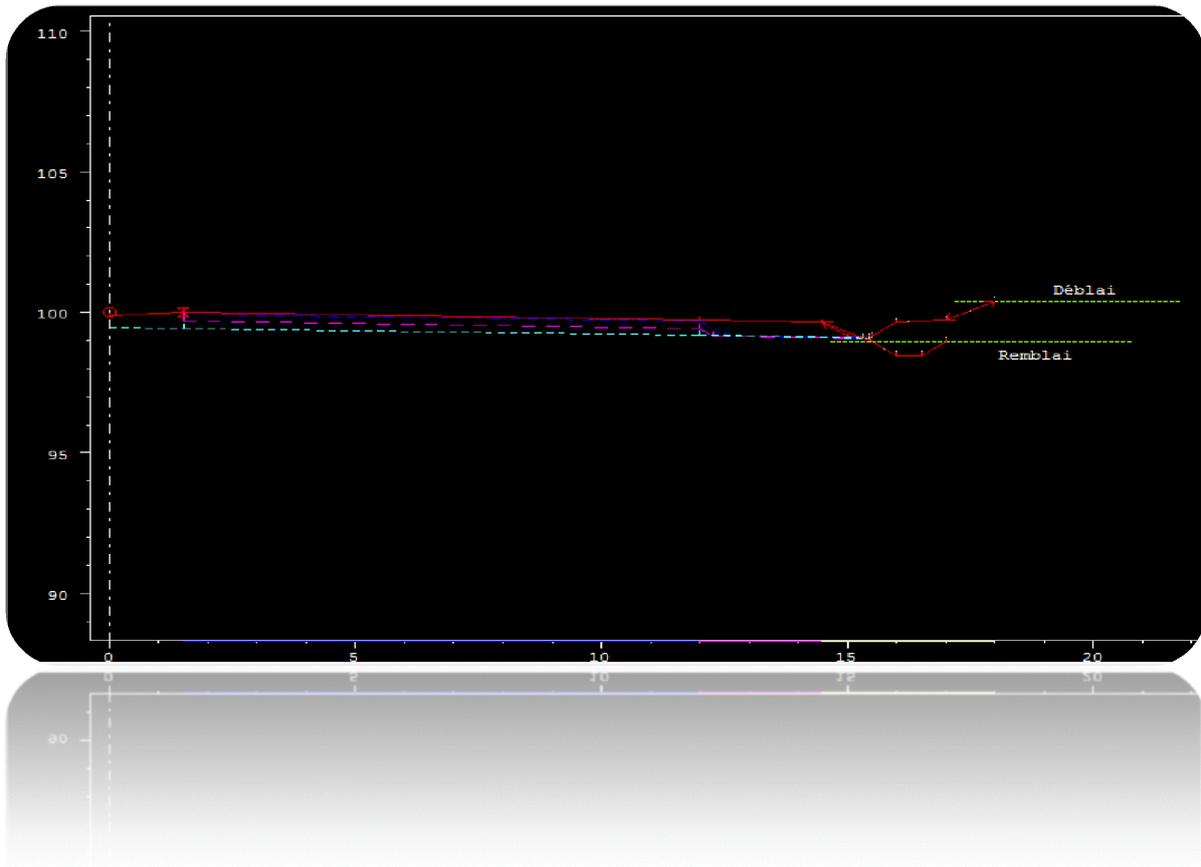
Image des Tableaux des caractéristiques de la chaussée profil en travers.
